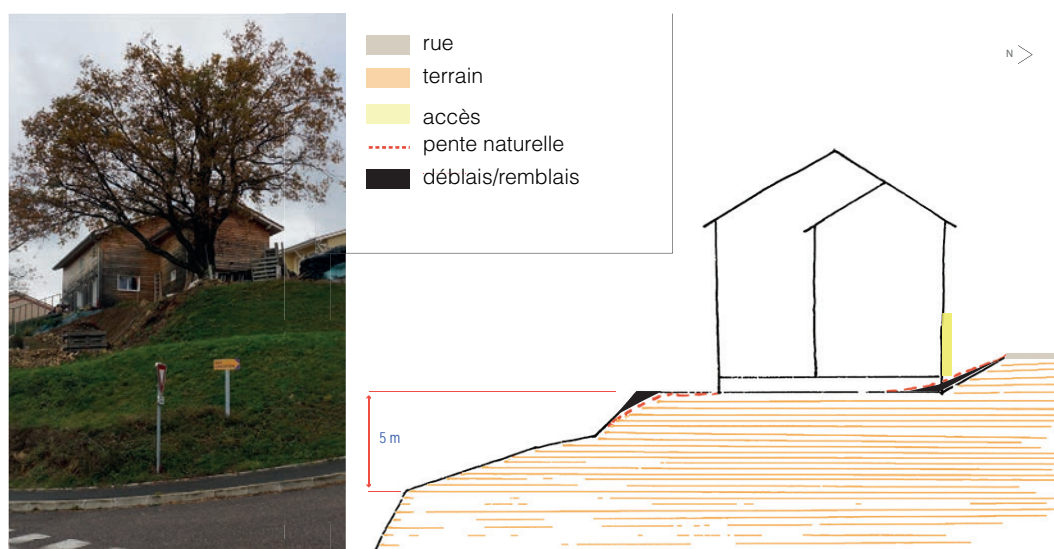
Lot 14 du Jardin de Rampeaux : une maison ossature bois bien implantée et adaptée à son terrain (source : dossier de demande permis de construire ; photo et croquis : L. Herrmann, 2016)
